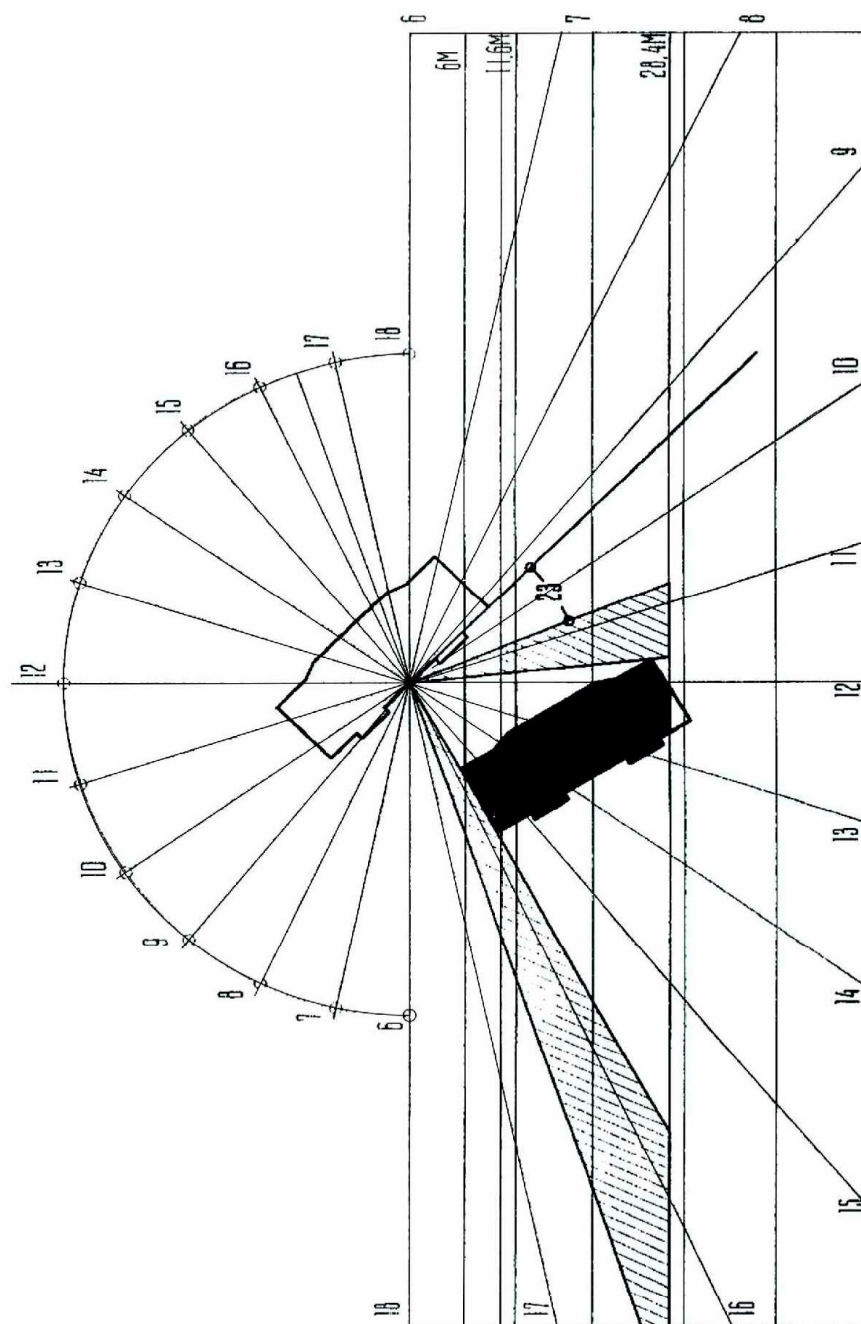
Расчет времени инсоляции точки фасада на уровне 1-го этажа с учетом затеняющего здания
